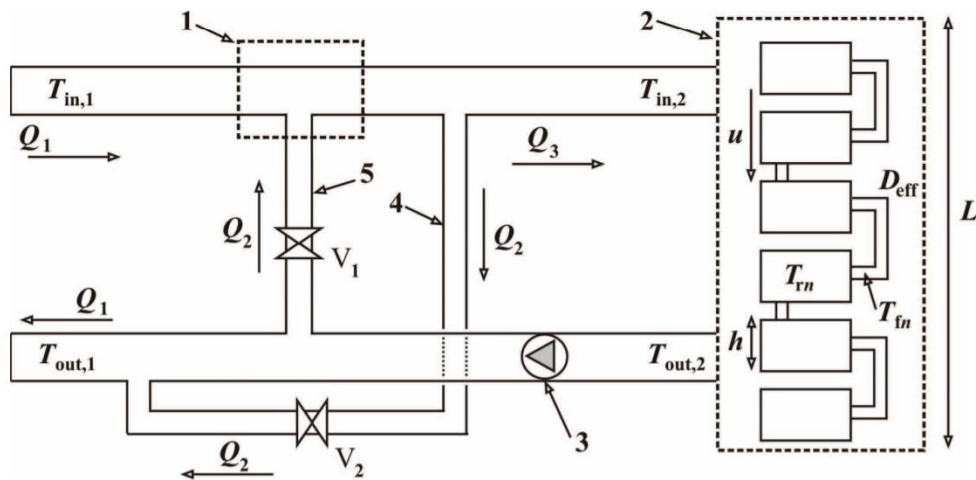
Гидравлическая схема теплового пункта (и здания), 1 – узел смешения; 2 – система отопления здания; 3 – циркуляционный насос; 4 – отводящий трубопровод; 5 – трубопровод для подачи теплоносителя в узел смешения; V1, V2 – вентили.
